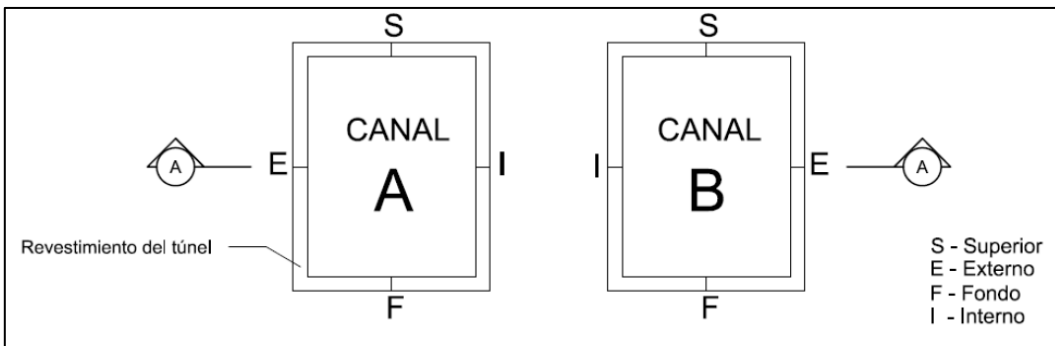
Disposición piezómetros en la zona de compuertas. Tomado de (Informe Final modelo hidráulico Descarga de Fondo Proyecto estudiado)
